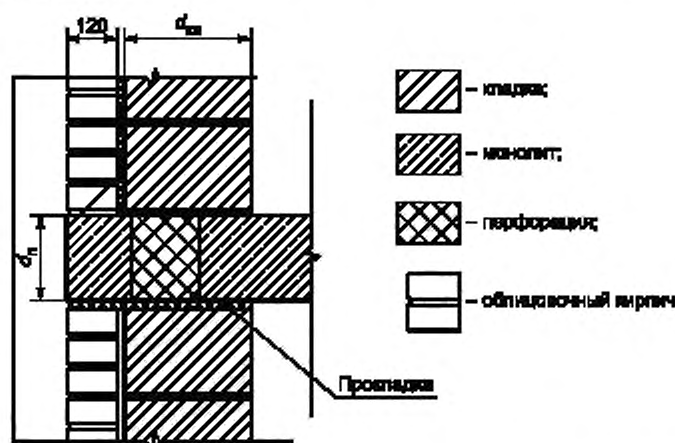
Схема узла сопряжения плиты перекрытия с наружной стеной
